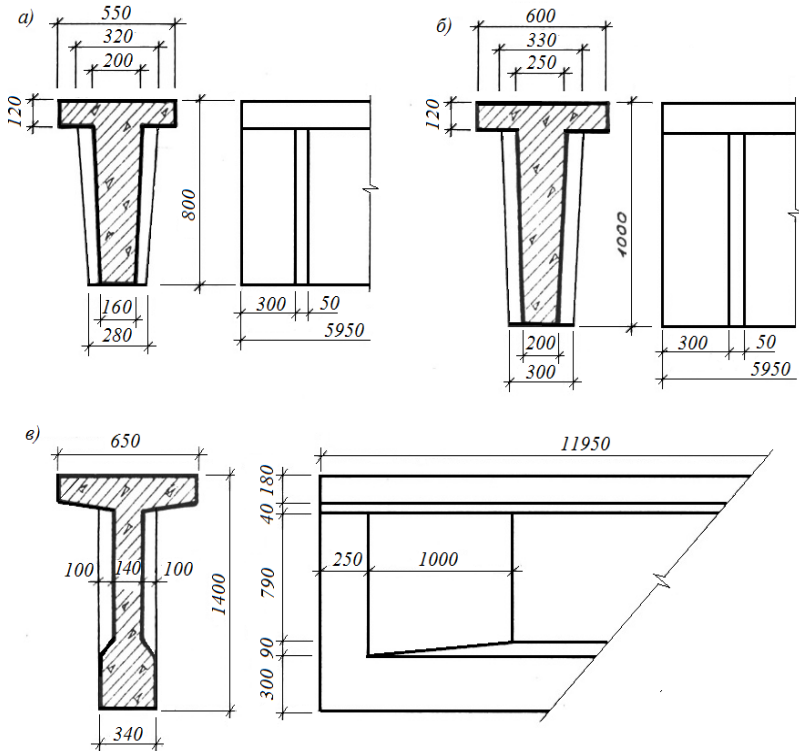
Залізобетонні підкранові балки довжиною: а, б – 6 м;
